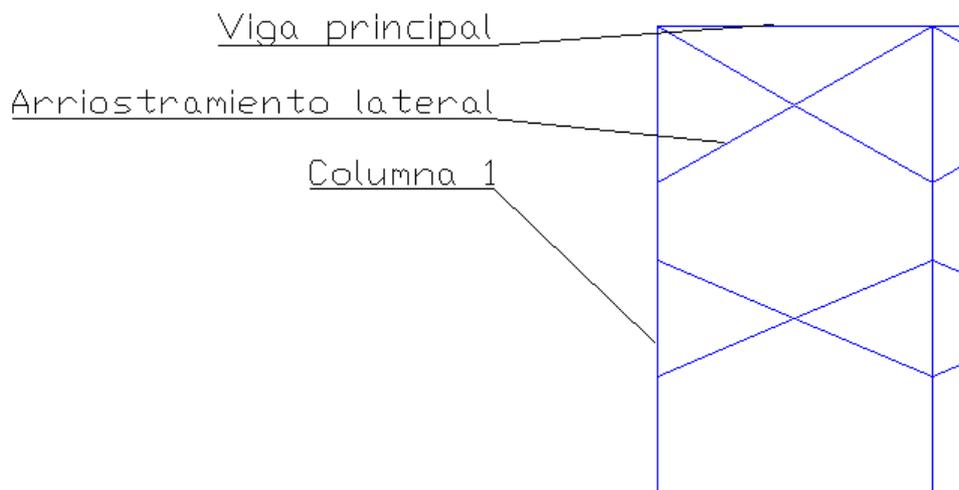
Detalle vista lateral elementos estructura marcos rígidos.
